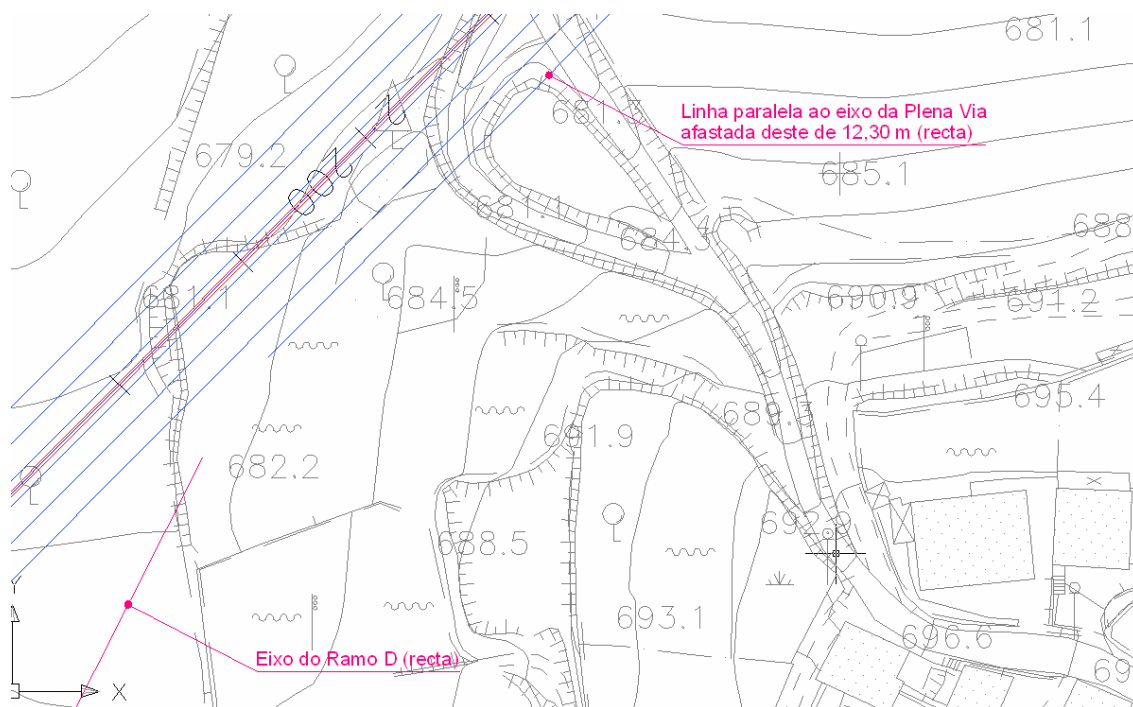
Construção da curva de ligação Ramo D/ Plena Via
